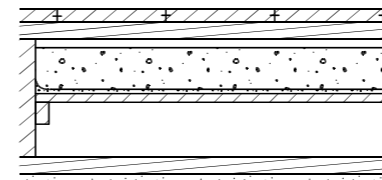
Tramdecke Gebäude Gl. 1:20
